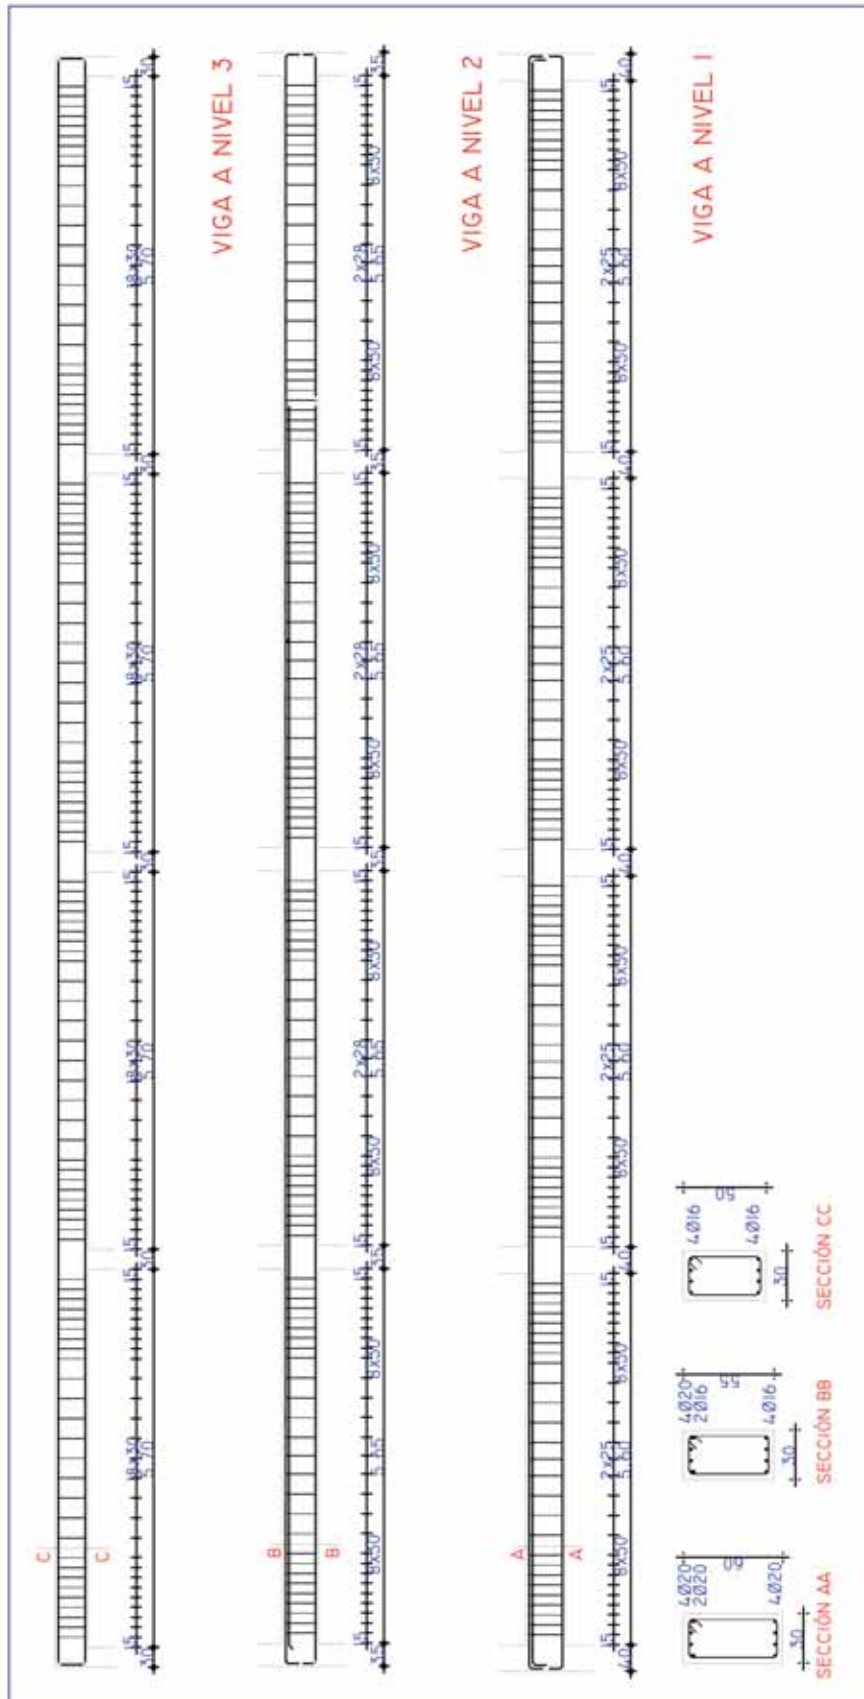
Detalles de armado de las vigas del pórtico exterior.
